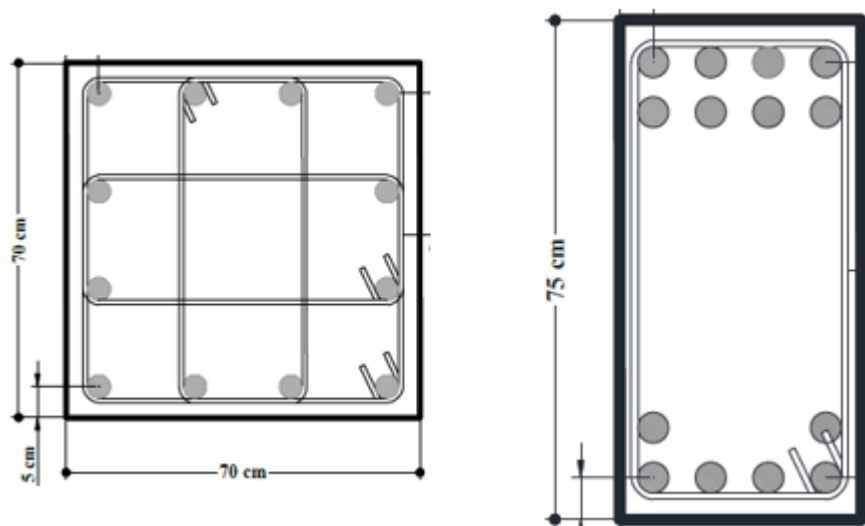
Armado tipo de columnas y vigas de edificio de CR de diez niveles (Hernández, 2016)
